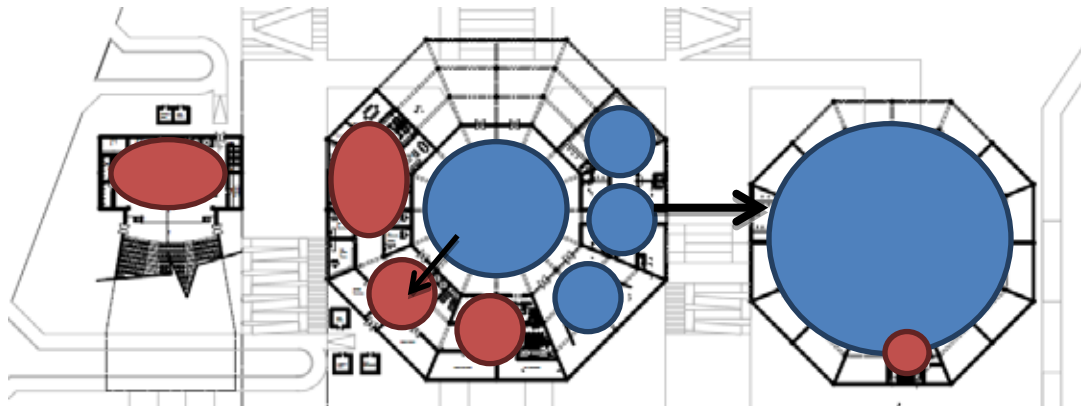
Esquema de funcionamiento Planta Conjunto. Nivel -1.00(2016)
